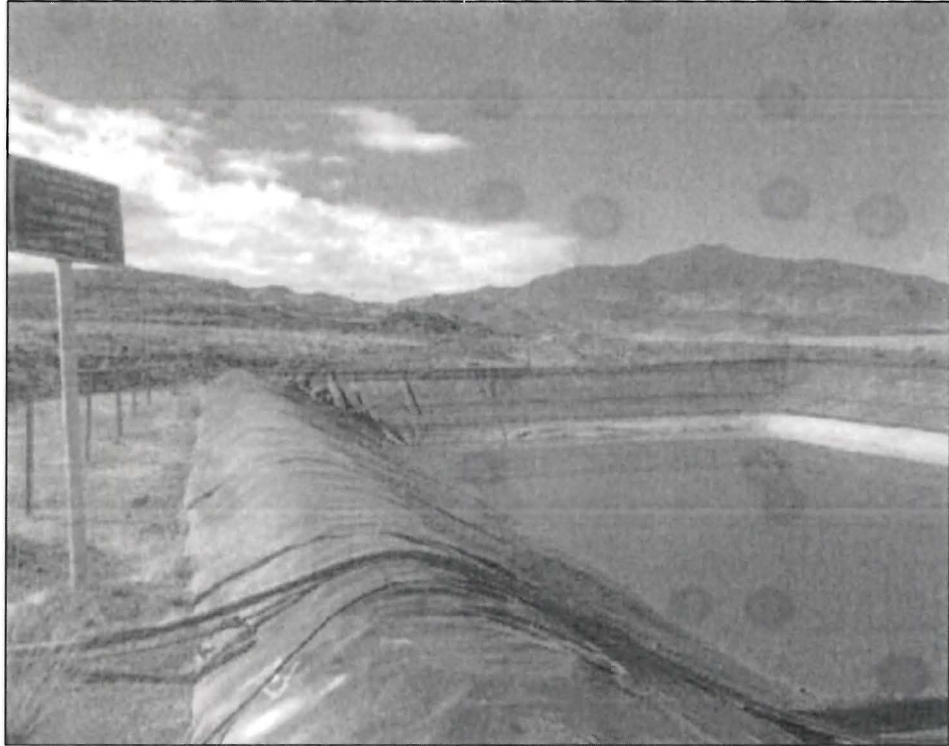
Vista de la tubería de descarga de la Poza debidamente sellada, así como de la bomba sumergible en funcionamiento y tuberías de subdrenaje
